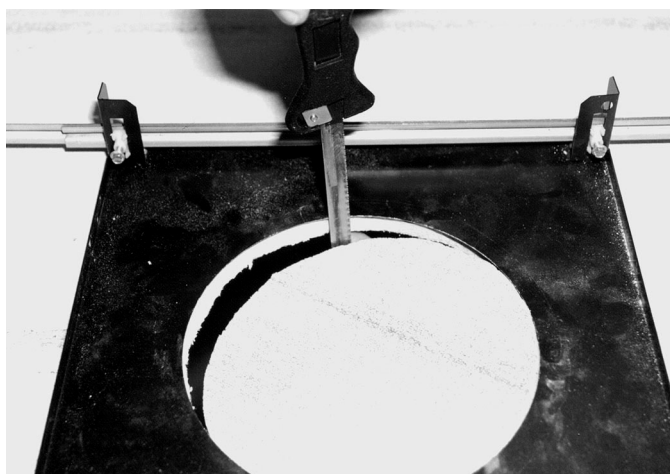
Découpe d'un trou dans la dalle de plafond
